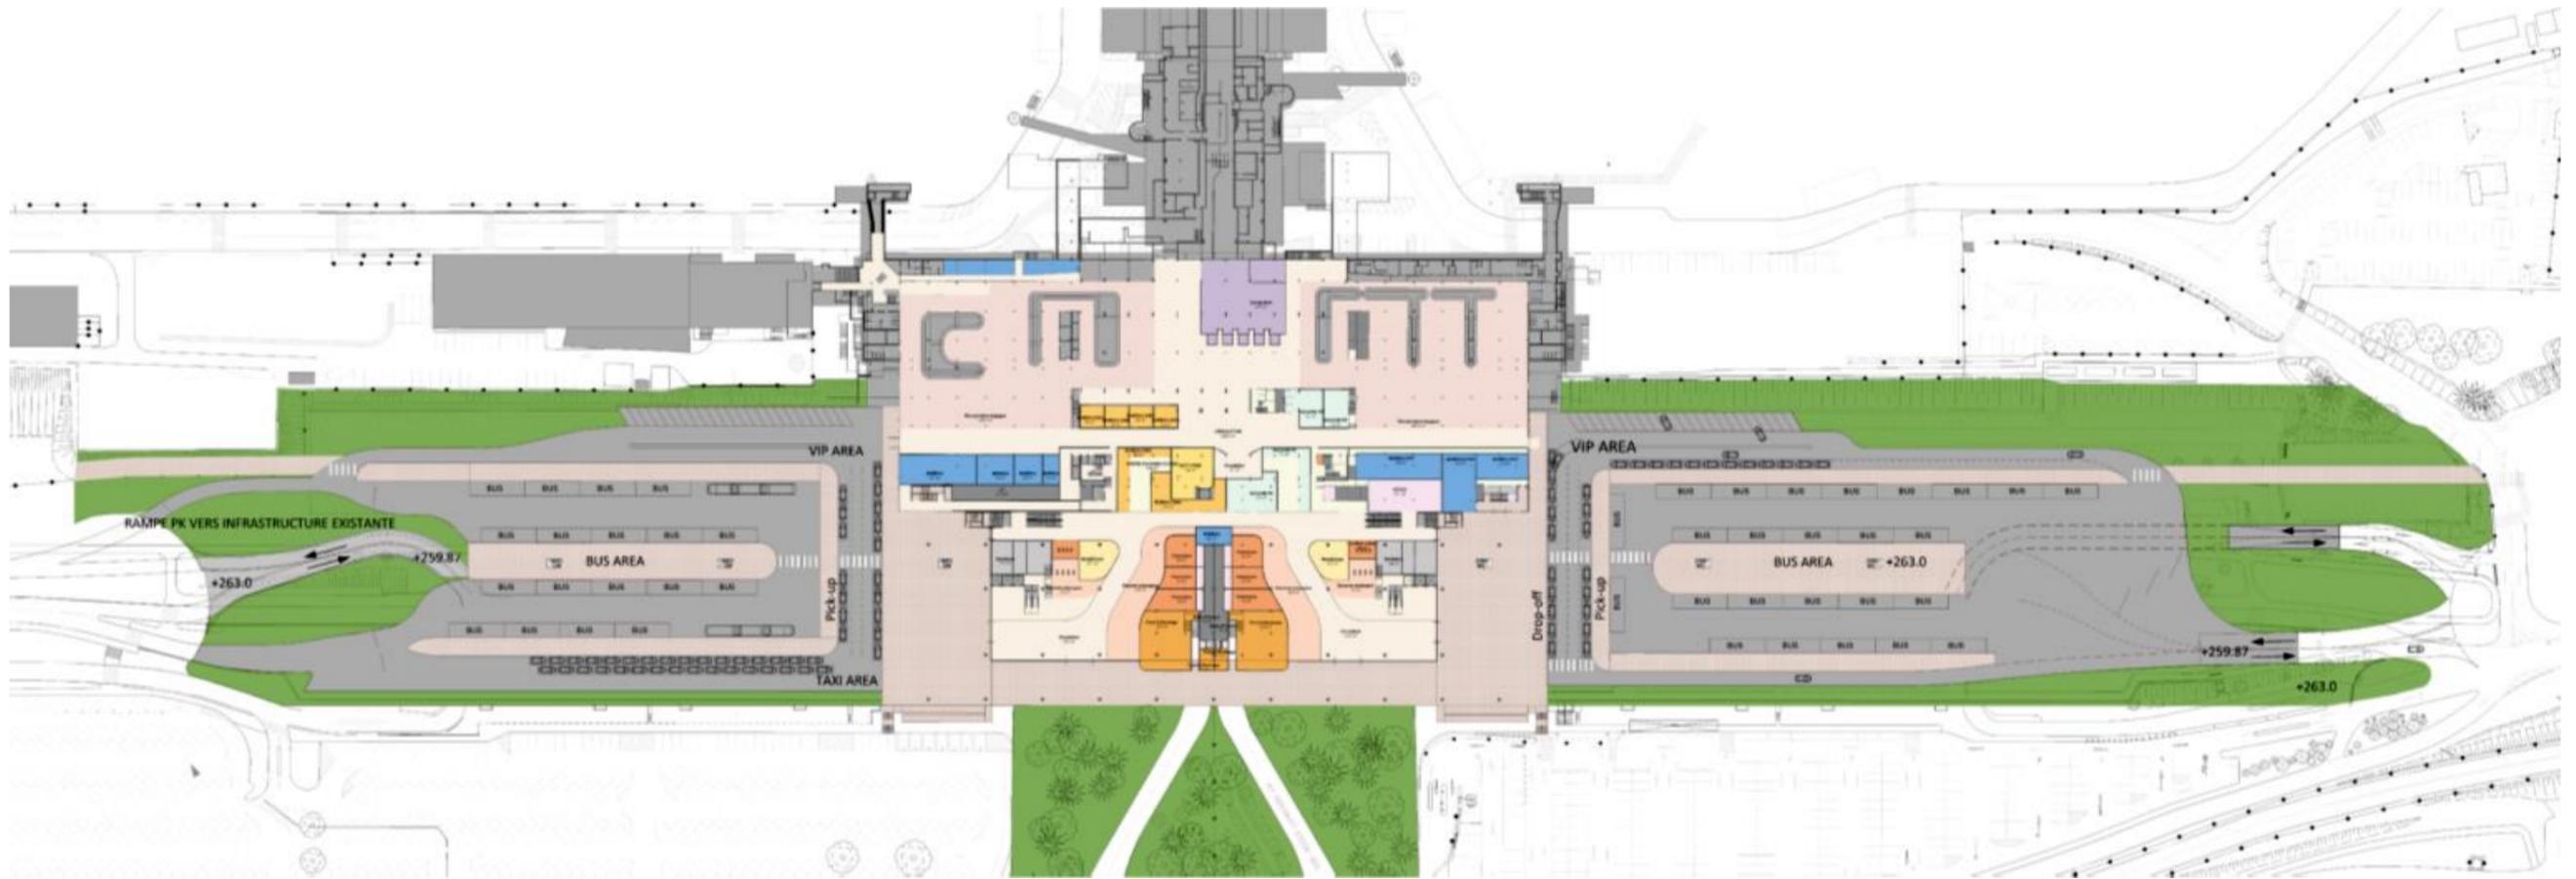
Plan des aménagements extérieurs : plateformes multimodales (A1)
